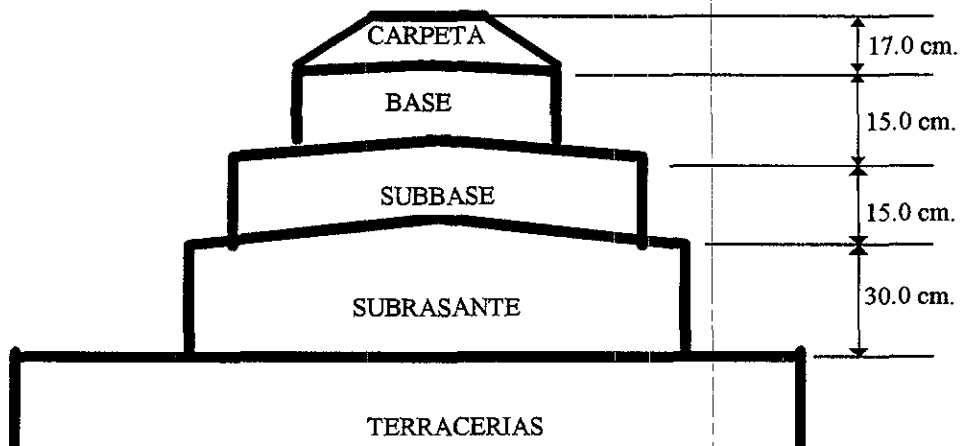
Espesores de las capas para el pavimento flexible, obtenidos mediante la aplicación del método AASHTO 86 para pavimentos flexibles.
